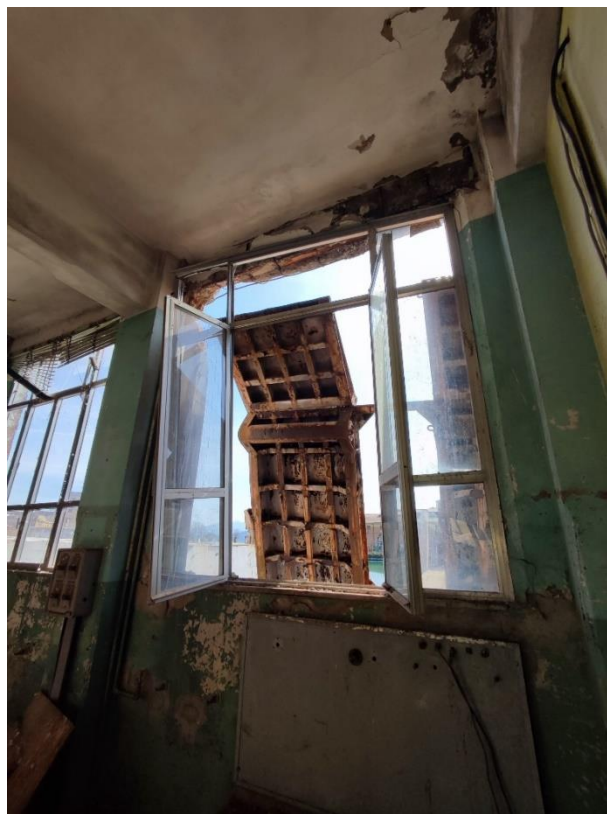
Fabbricato 153 - Dettaglio finestra piano terra (fronte darsena) e scale di accesso piano primo
